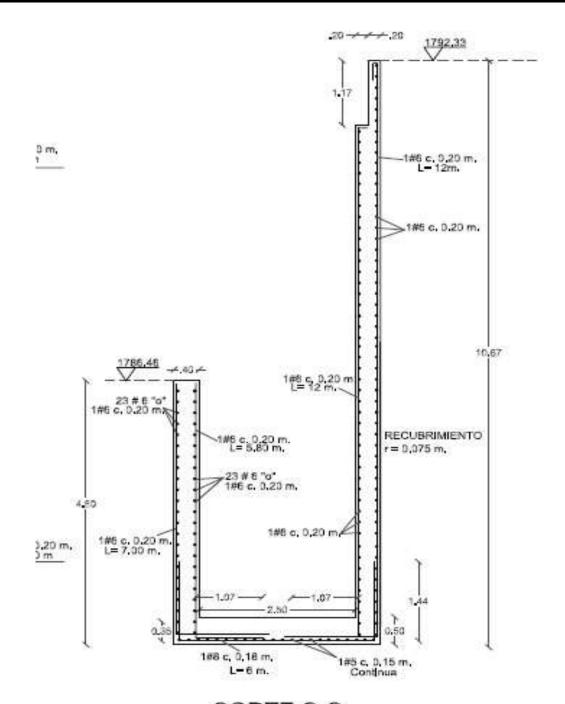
DESPIECE ACERO HORIZONTAL
